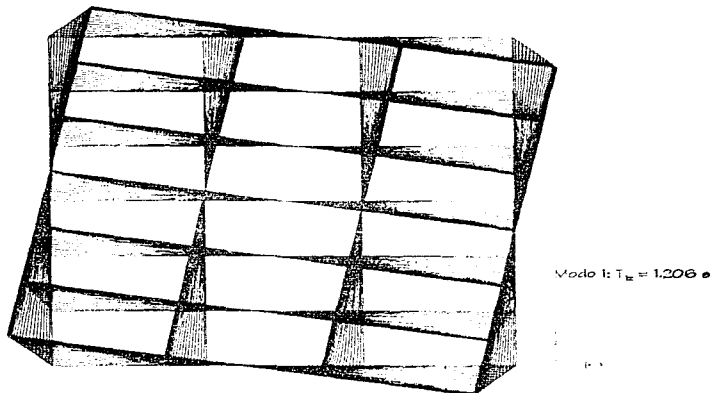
Vista en planta del modo fundamental de vibración en torsión, estructura de 17 niveles diseñada en la zona III
